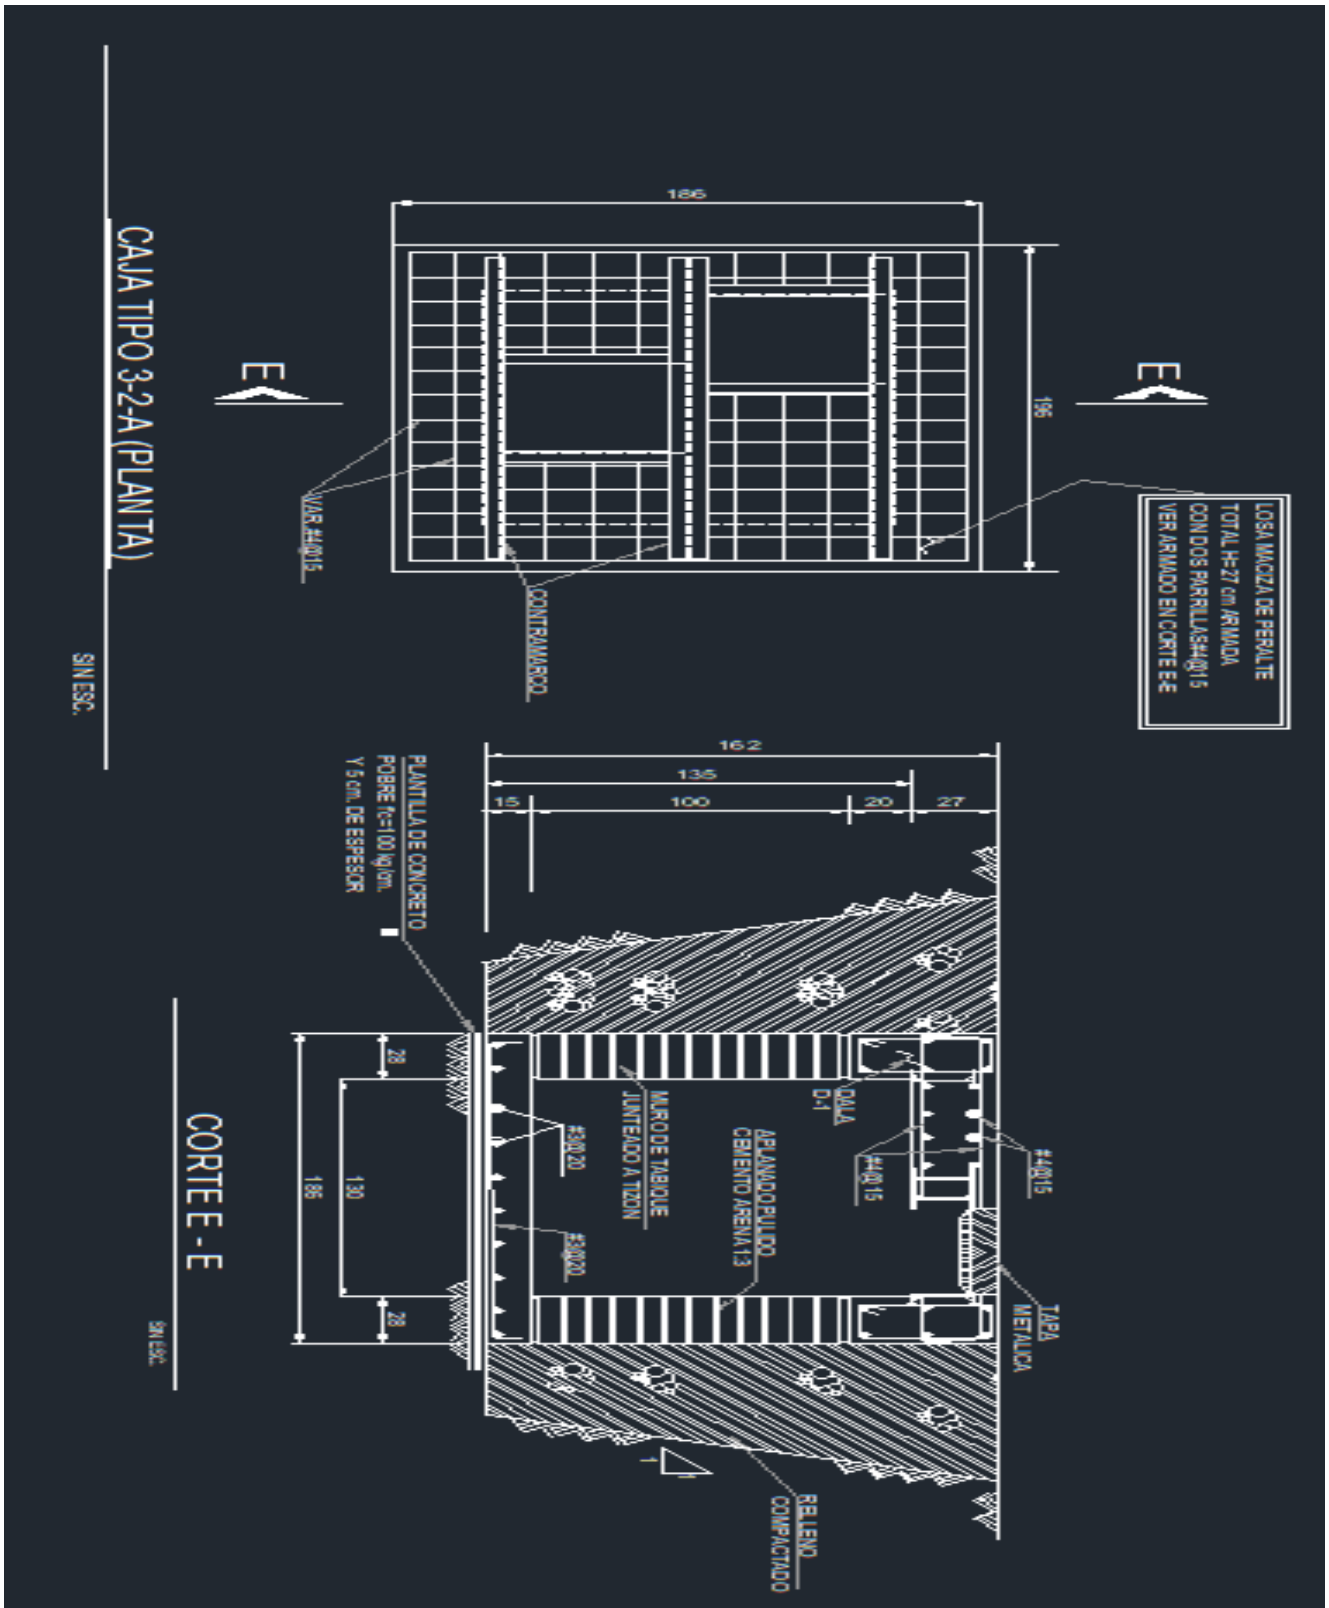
Especificación del proceso constructivo de caja tipo 3-2-A. Fuente: elaboración propia
